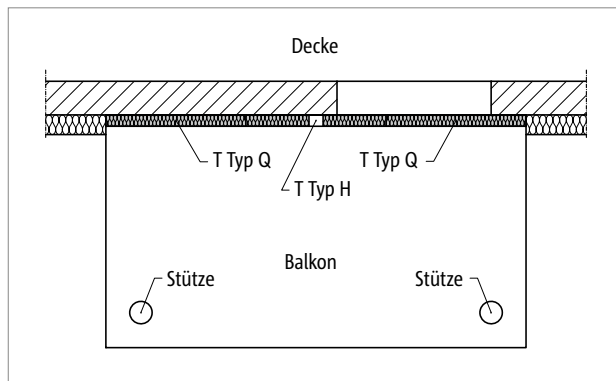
Schöck Isokorb® T Typ H: Balkon mit Stützenlagerung
